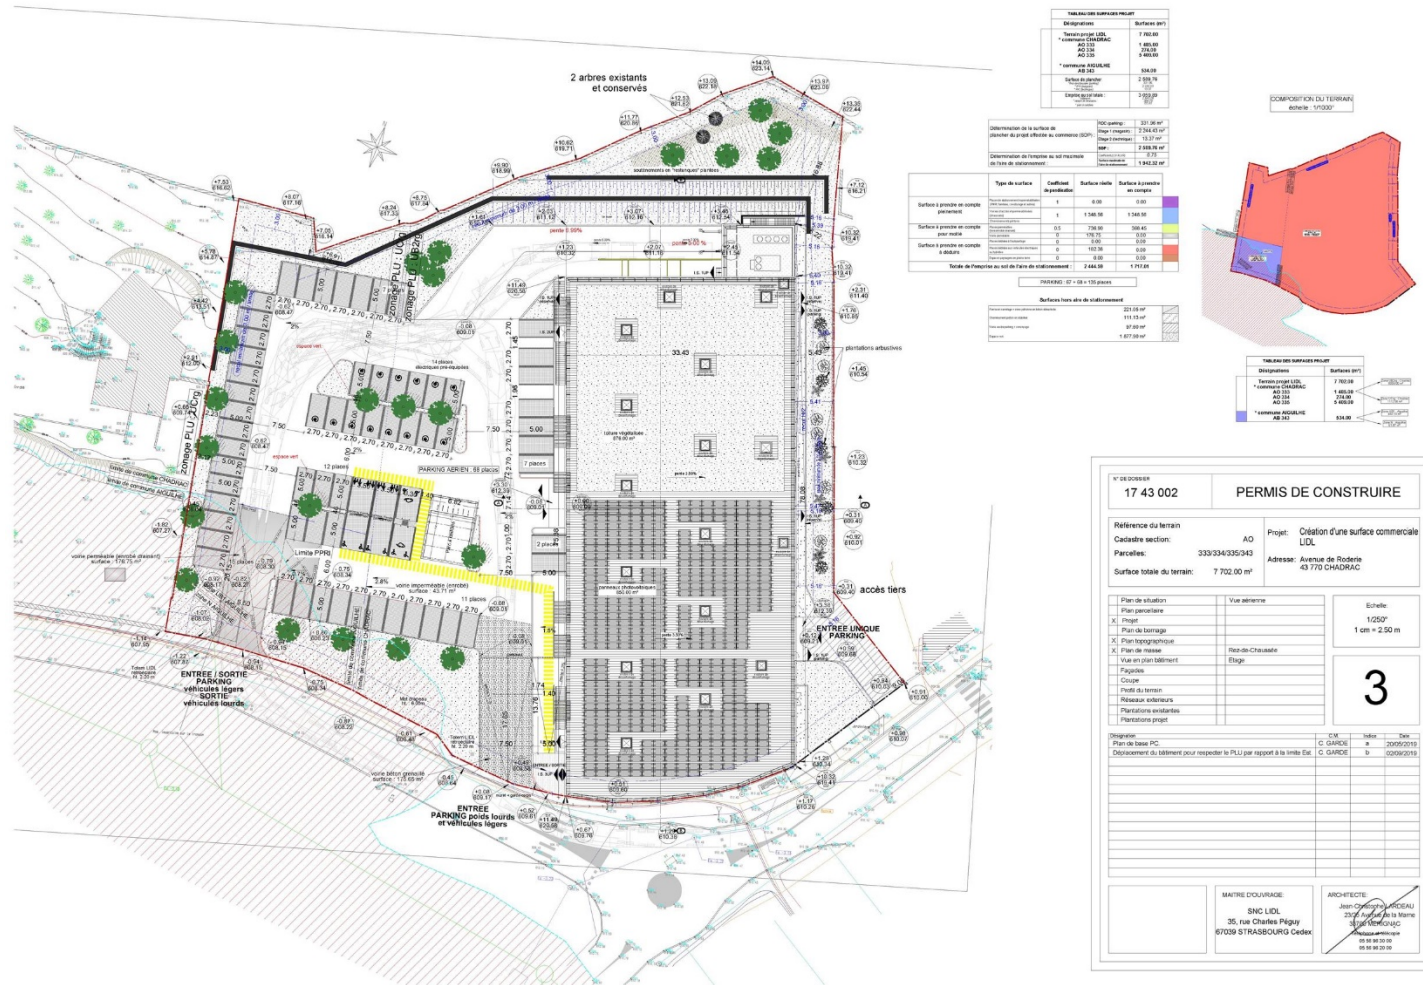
Plan masse du projet (Source Cabinet d'Architecte LARDEAU, version 02/09/2019)
